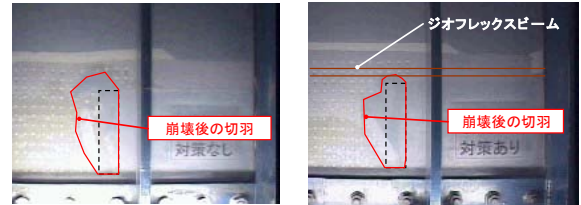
切羽崩壊直後の状況 Tunnel Face Failure
